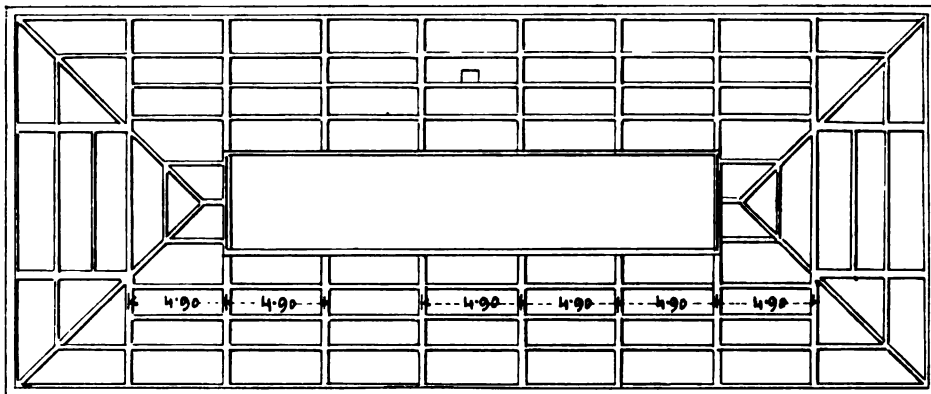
Laboratoriumsgebäude in New-York. Grundriß.
